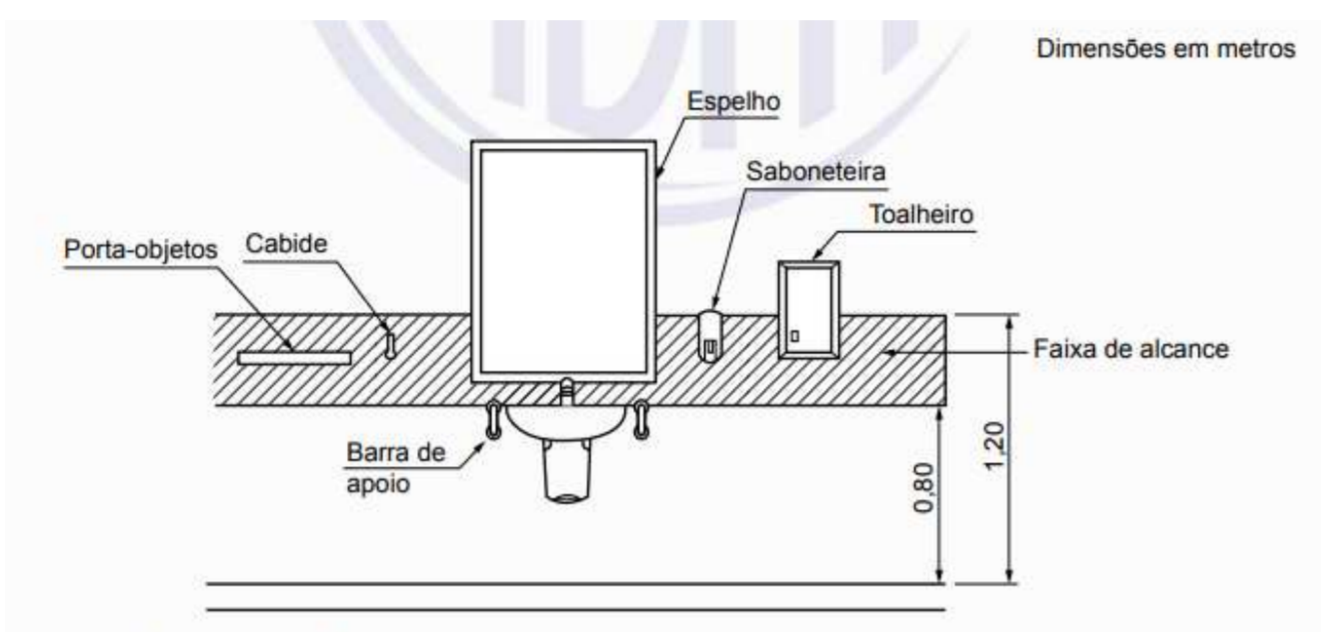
Faixa de alcance de acessórios junto ao lavatório – Vista frontal
